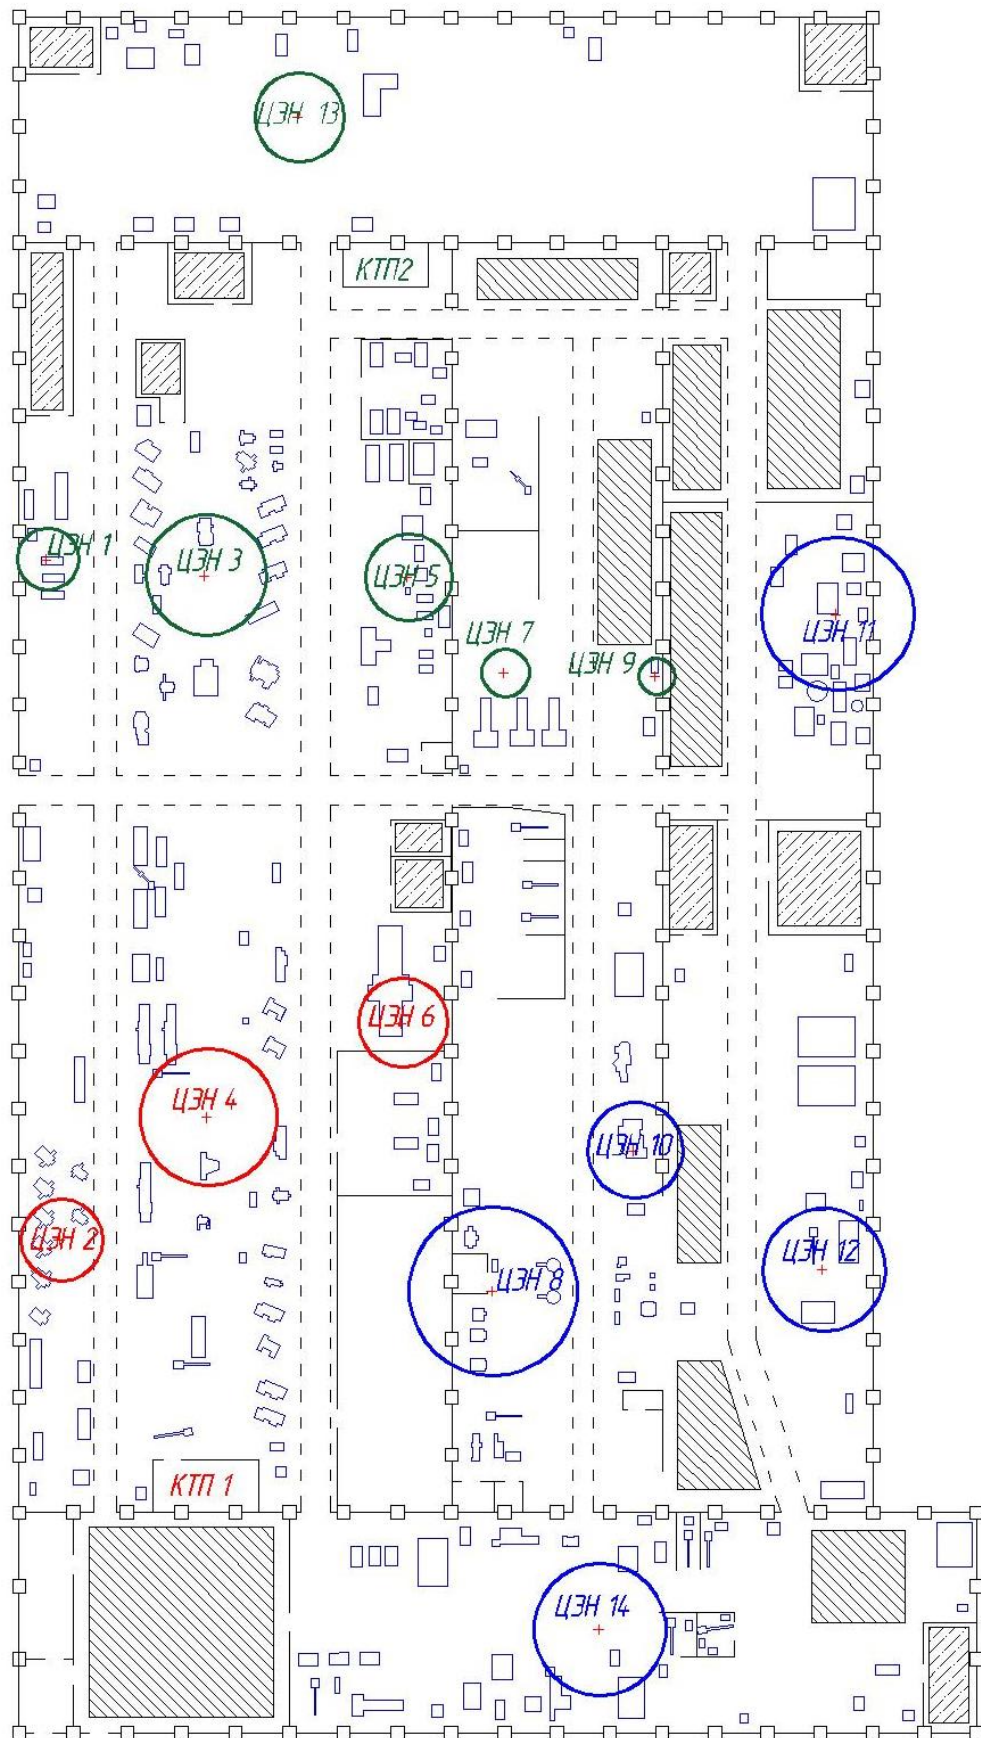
Расположение ЦЭН механосборочного цеха
